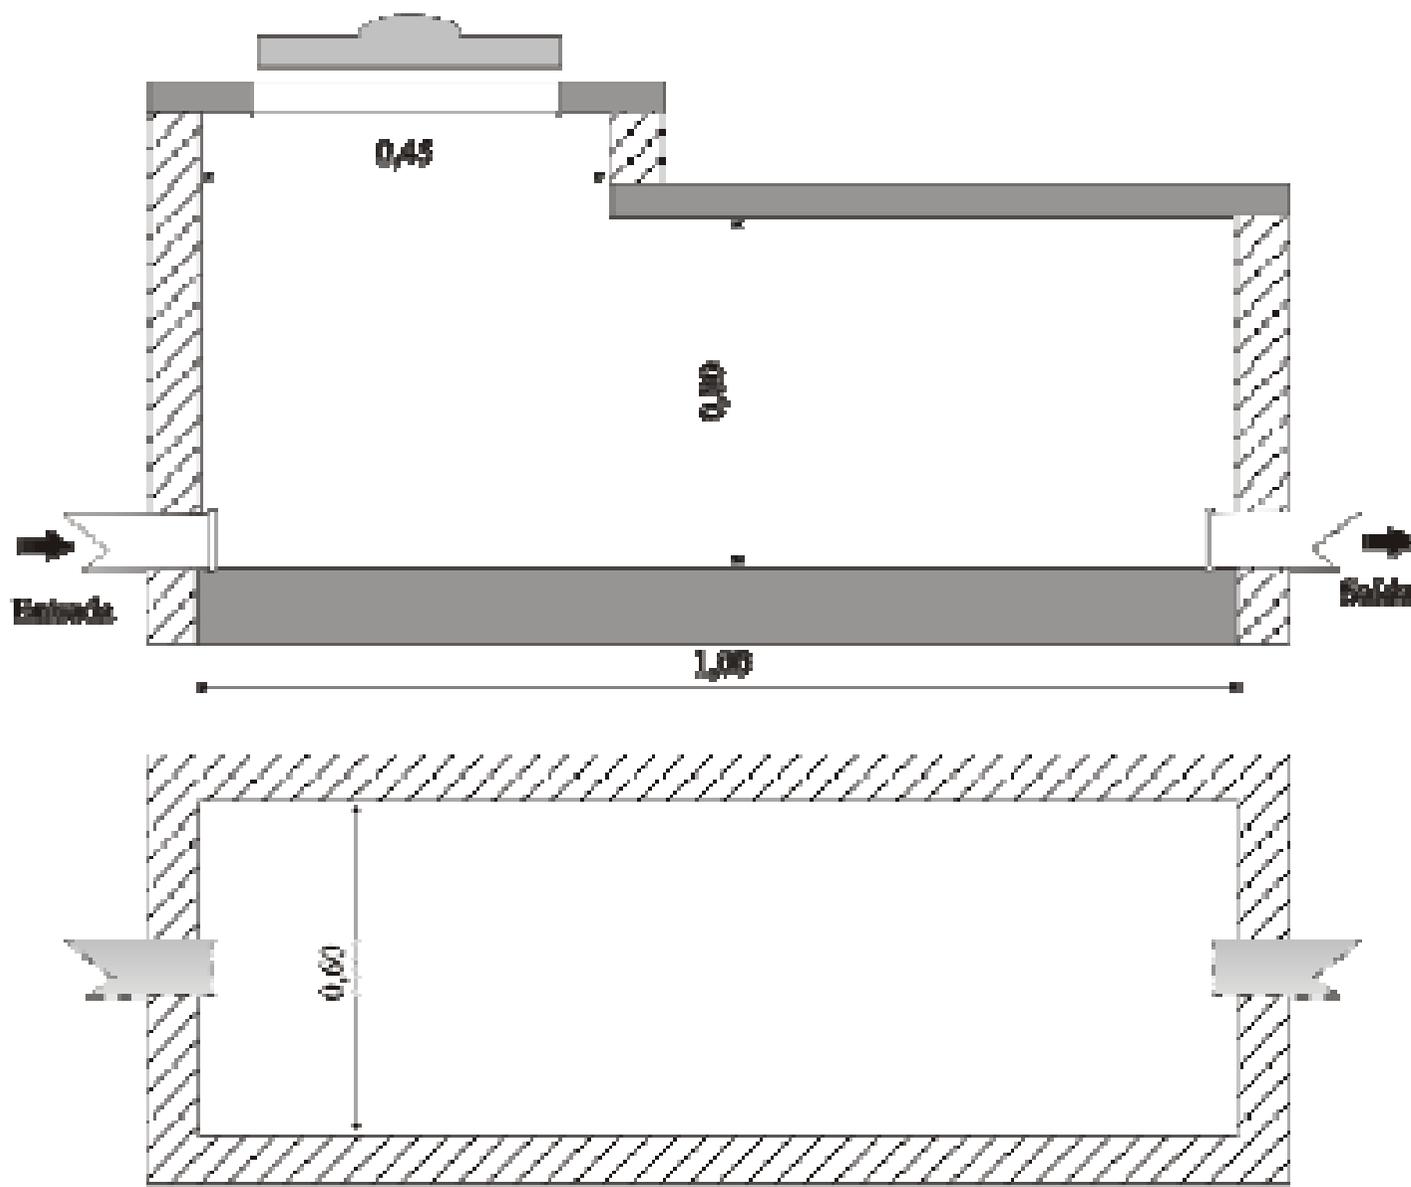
Detalhe do dimensionamento da caixa de inspeção
